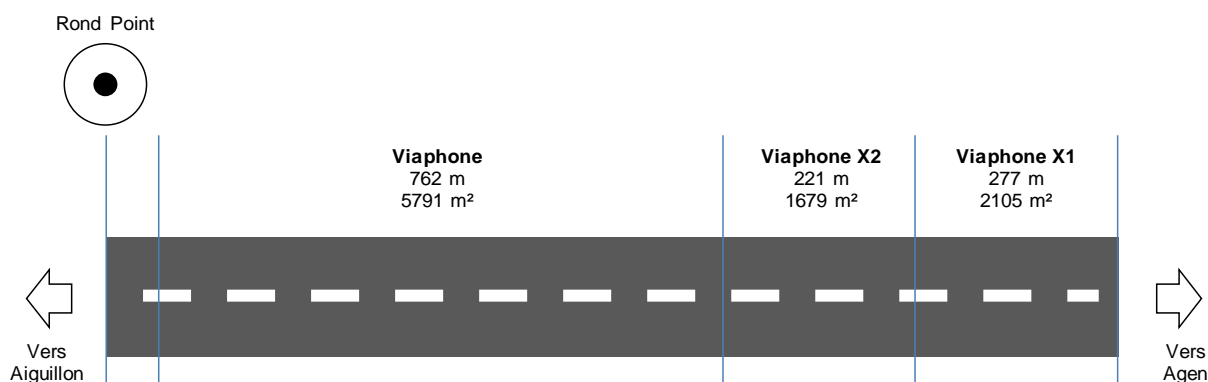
Implantation des trois planches expérimentales sur la section 1 de la RD 911
